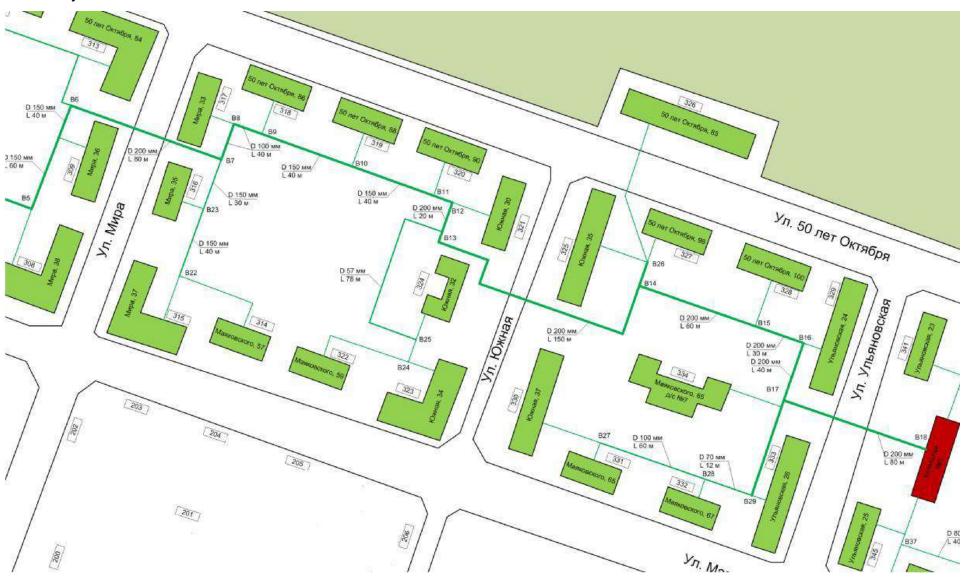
Схема тепловых сетей котельной №3 г. Кинель
